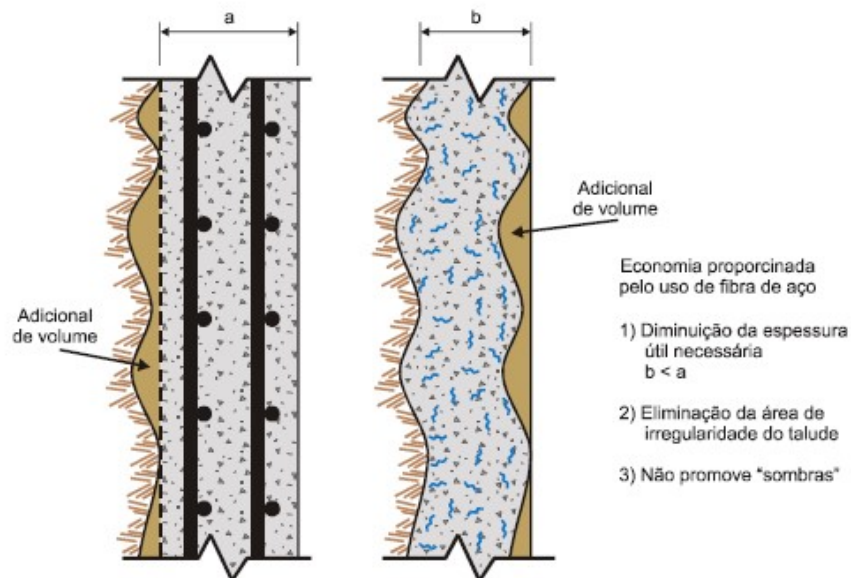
Detalhe das fibras metálicas misturadas no concreto
